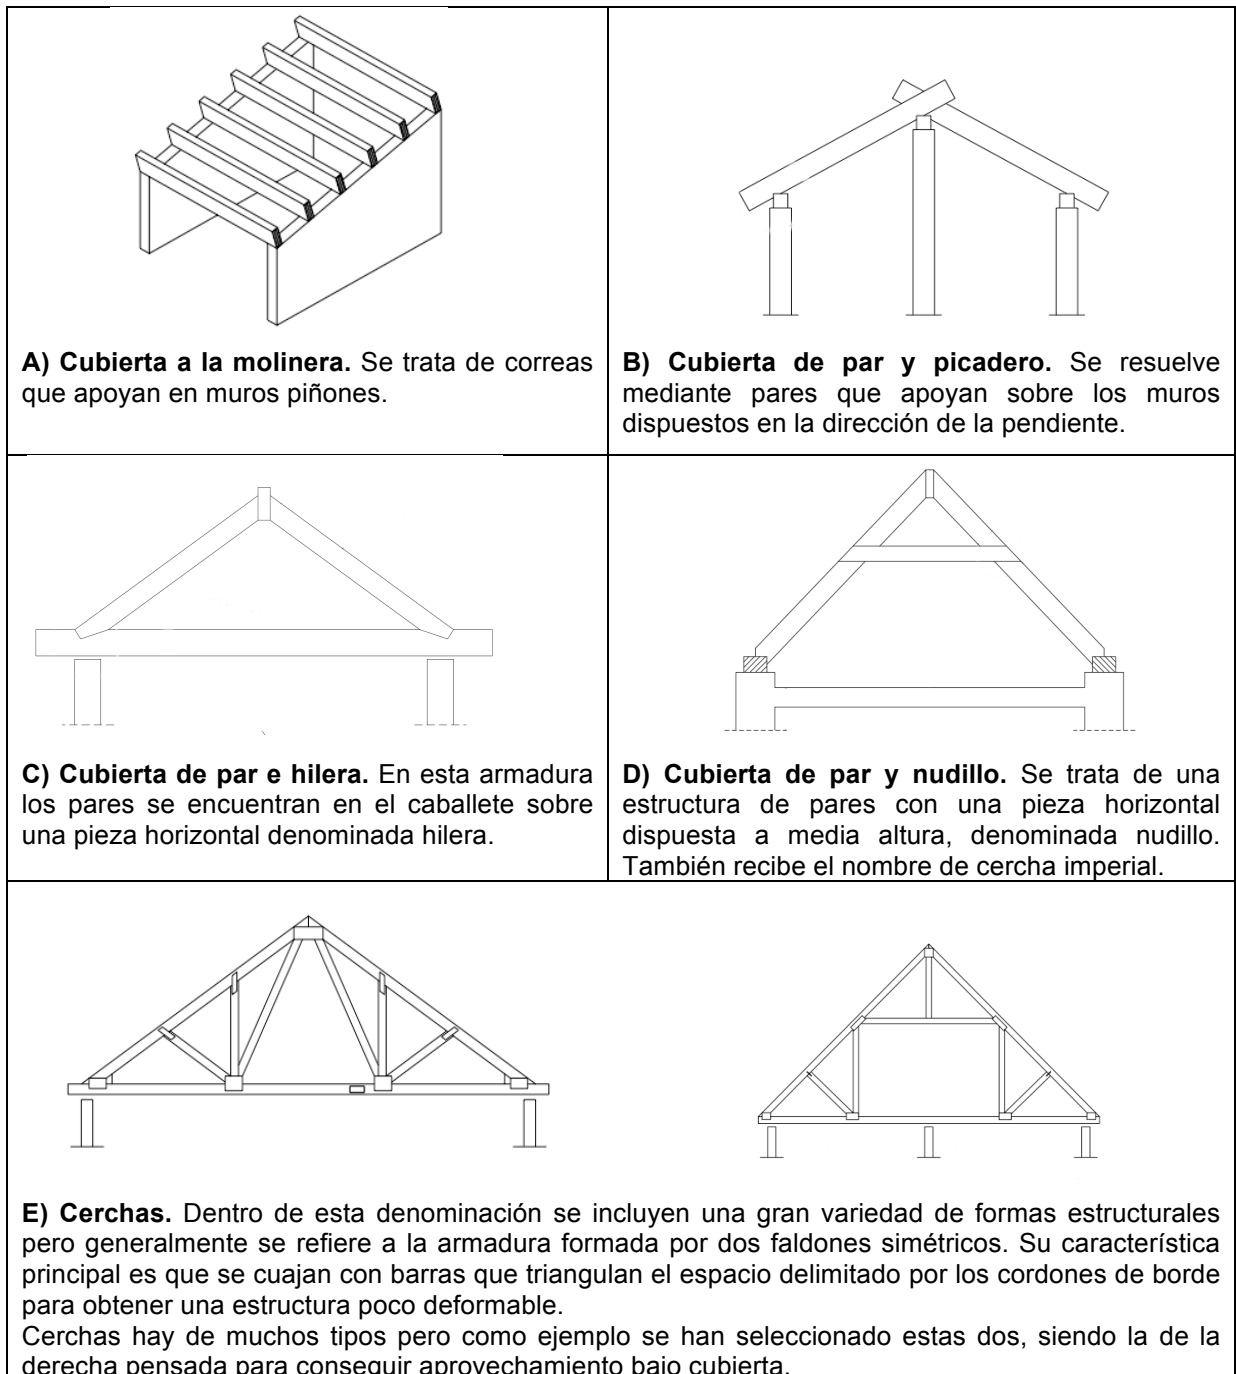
Posibles tipos de cubierta en la construcción con entramado ligero de madera
